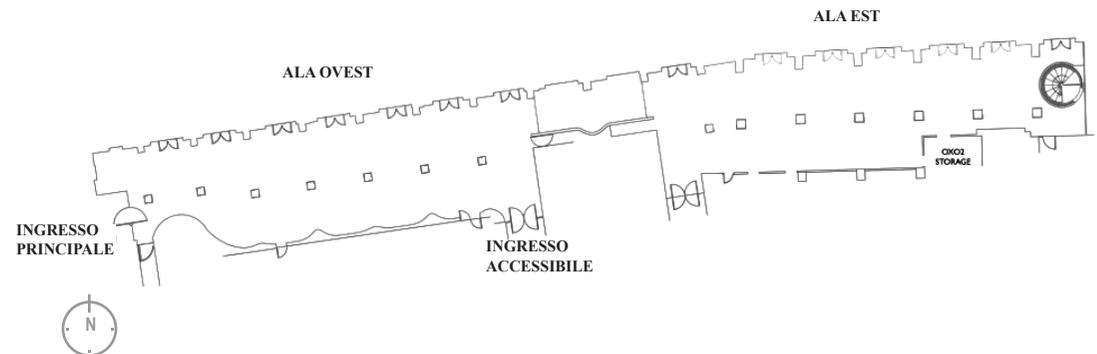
OXO Tower*, pianta attuale del piano terra.
